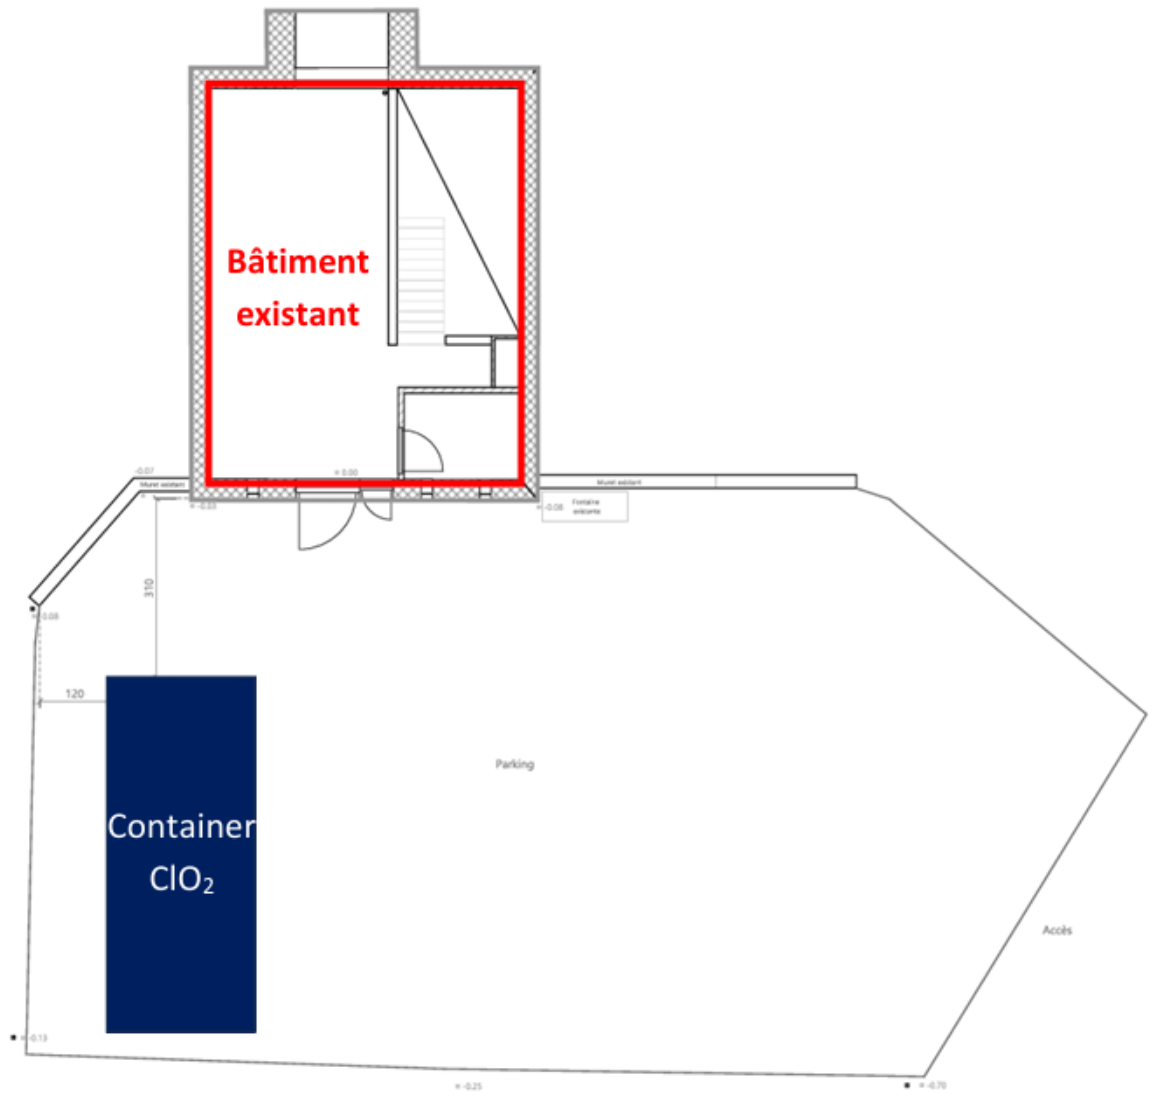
IMPLANTATION DU CONTAINER SUR LE SITE DE RIONDET.
